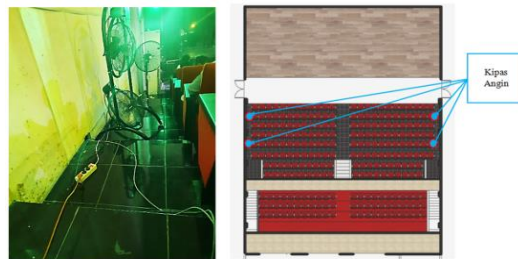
Layout Kursi Lantai Dasar dan Balkon Ruang Pertunjukan
